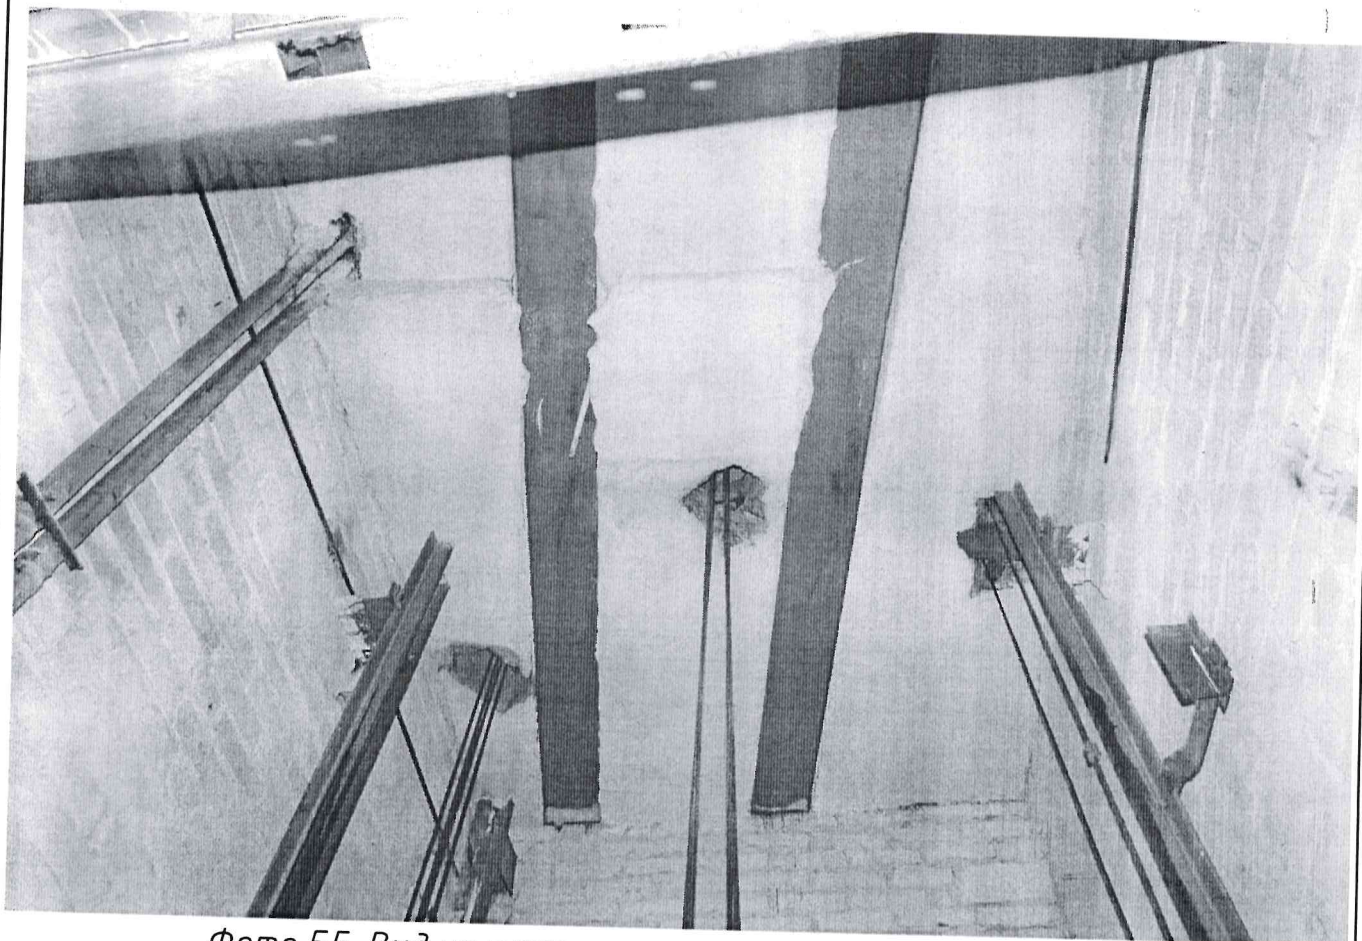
Вид на плиту перекрытия лифтовой шахты
